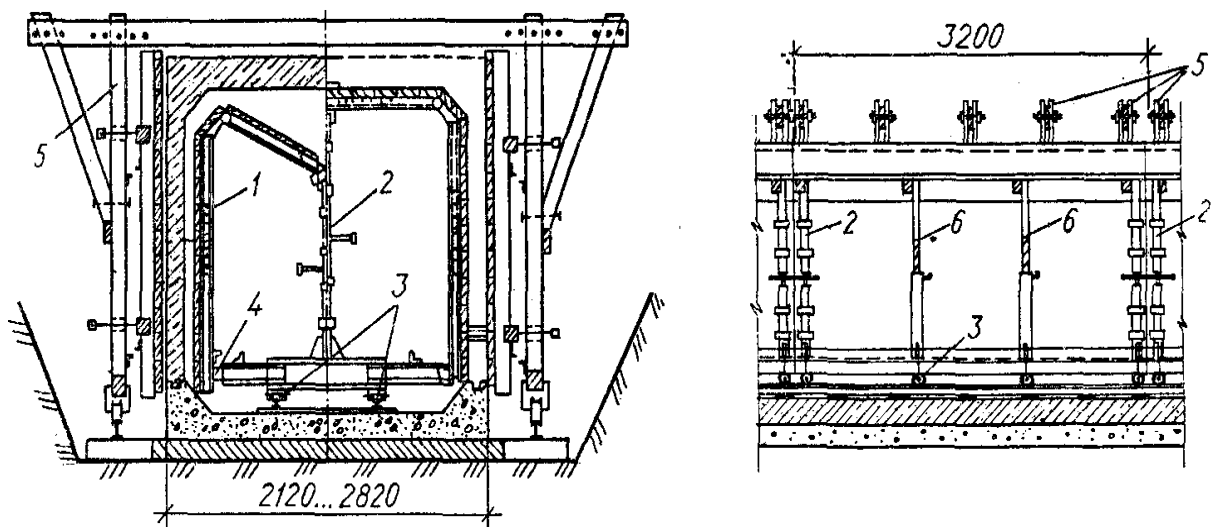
Котюча опалубка для бетонування тунелів прямокутного перерізу, що зводяться відкритим способом:
